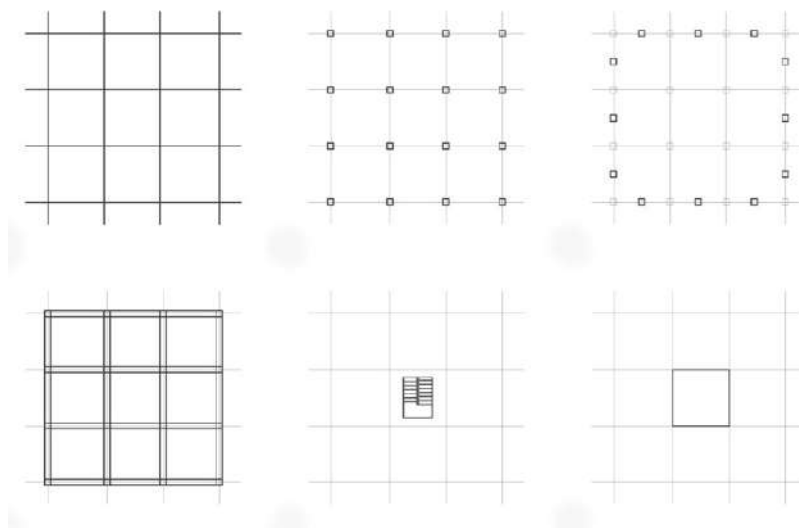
Planta do sistema estrutural da tipologia pavilhonar 3x3 (Santos, 2015)
